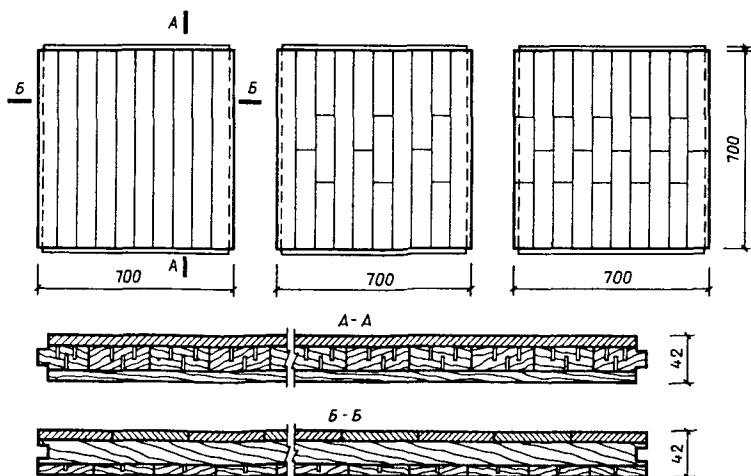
Паркетные щиты — возможные конструкции и размеры
